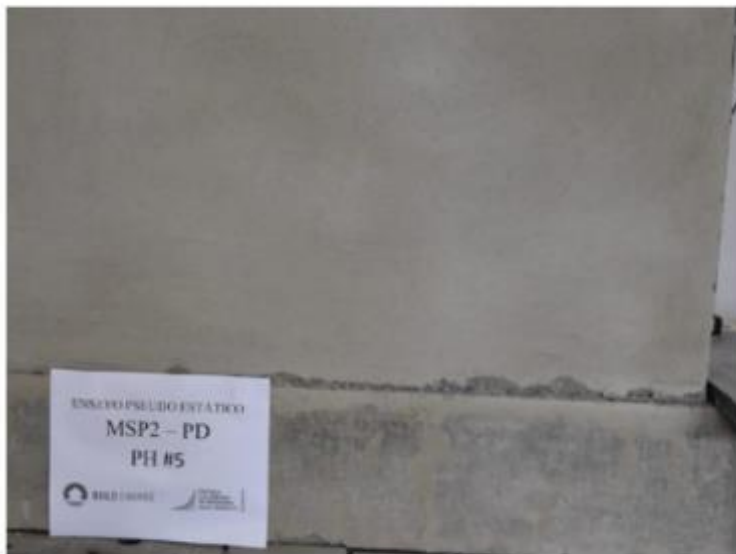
Fisuración en base del muro por ausencia de anclaje; falla por compresión en pañete – MSP2.
